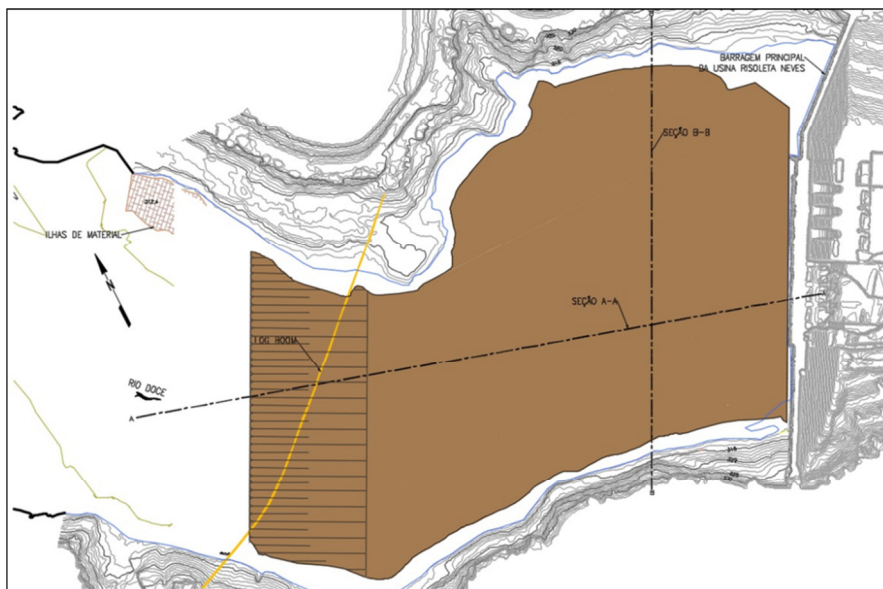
Planta de dragagem EL.302 – Fase 2 - 1a Etapa
